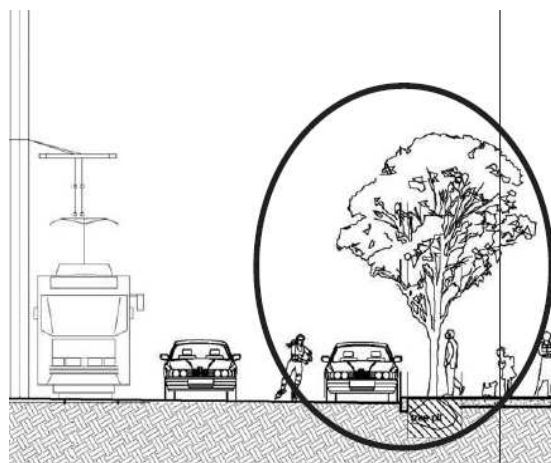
Esquema de perfil de via com sistema de biofiltração (planter box)
